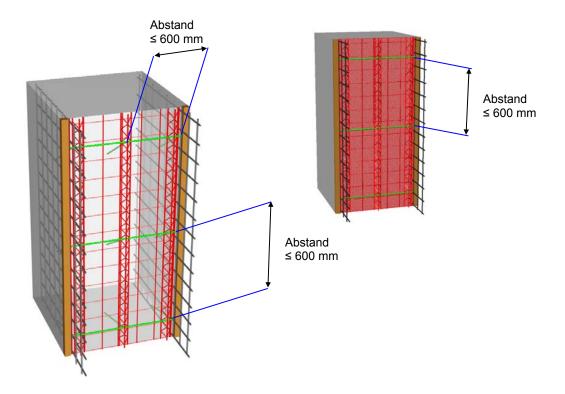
Detailansicht einer mit Stremaform geschalten Fuge mit mehr als 300 mm Dicke
